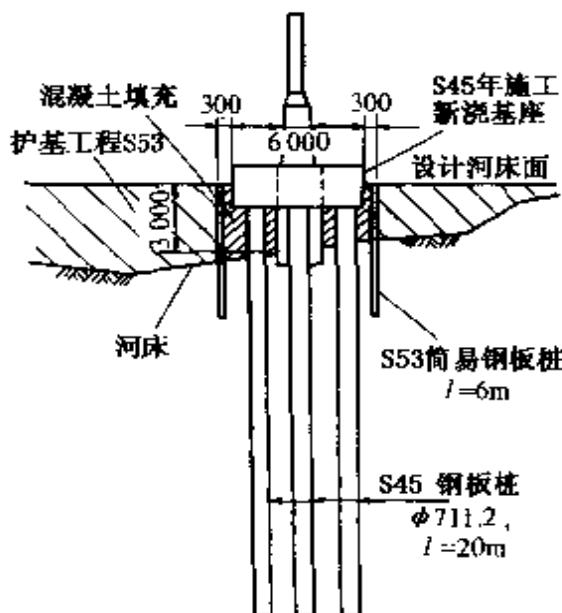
用板桩与混凝土填充加固基础的方法(尺寸单位:cm)
